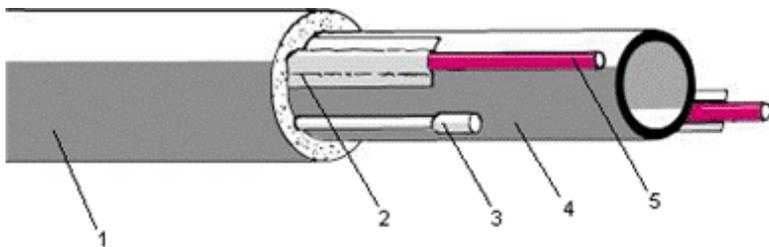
Монтаж нагревательного кабеля ДЕВИ Flex-10Т на металлической водопроводной трубе.
